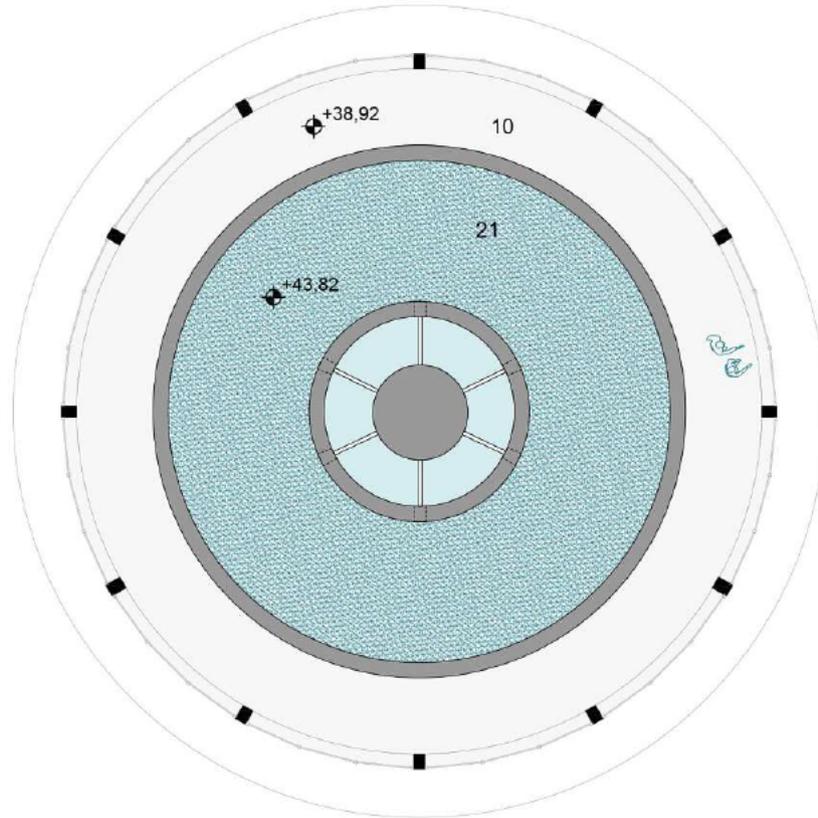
Grundriss 8.Obergeschoss
